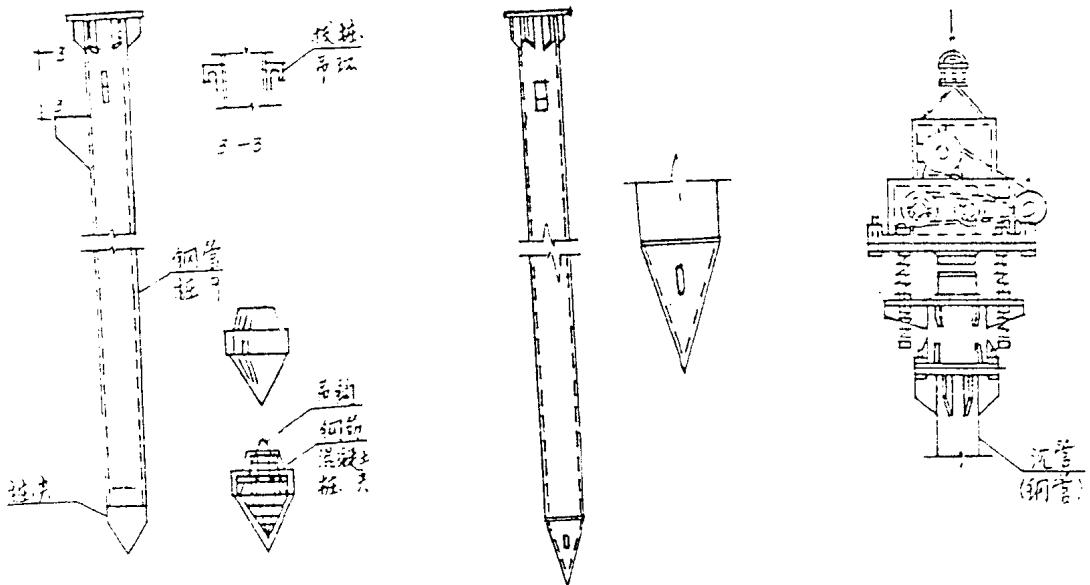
预制钢筋混凝土桩尖沉管 封闭型桩尖沉管 图 5-9 振动冲击沉管桩锤
